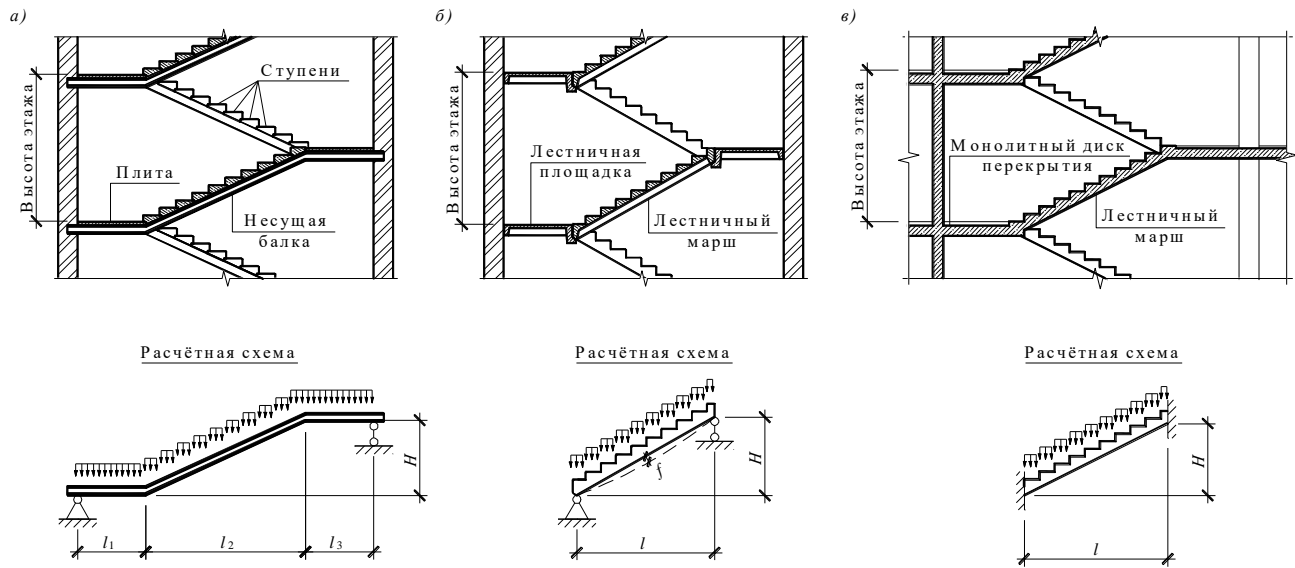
Варианты исполнения железобетонных лестниц:
